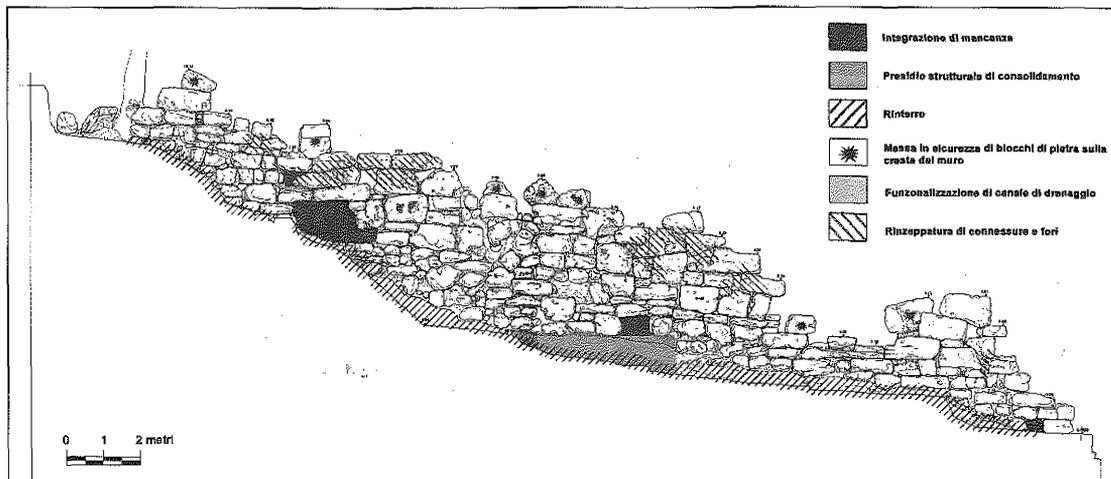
Volterra. Località S. Andrea, muro etrusco: prospetto principale con proposta di interventi.
